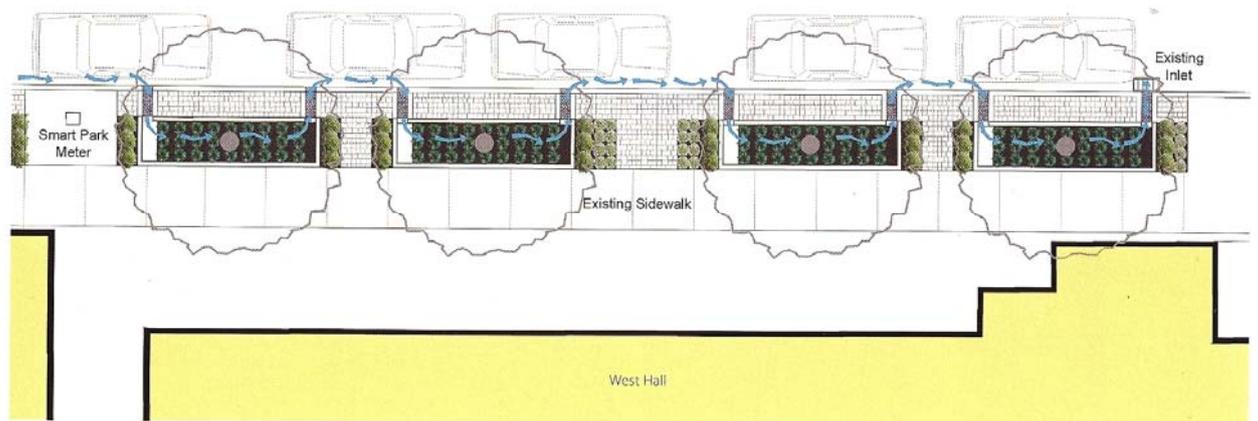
Propuesta de sistema de drenaje en SW 12th Avenue Green Street, Portland, Oregon².
